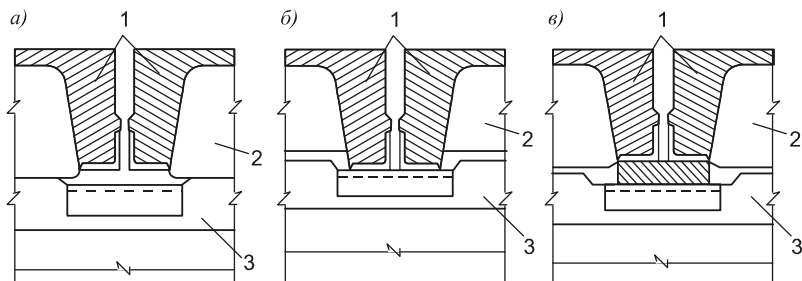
Схема дефекта узла опирания плит перекрытий на ригели и его исправления в каркасных зданиях серии ИИ-20/70 и 1.420-12:
